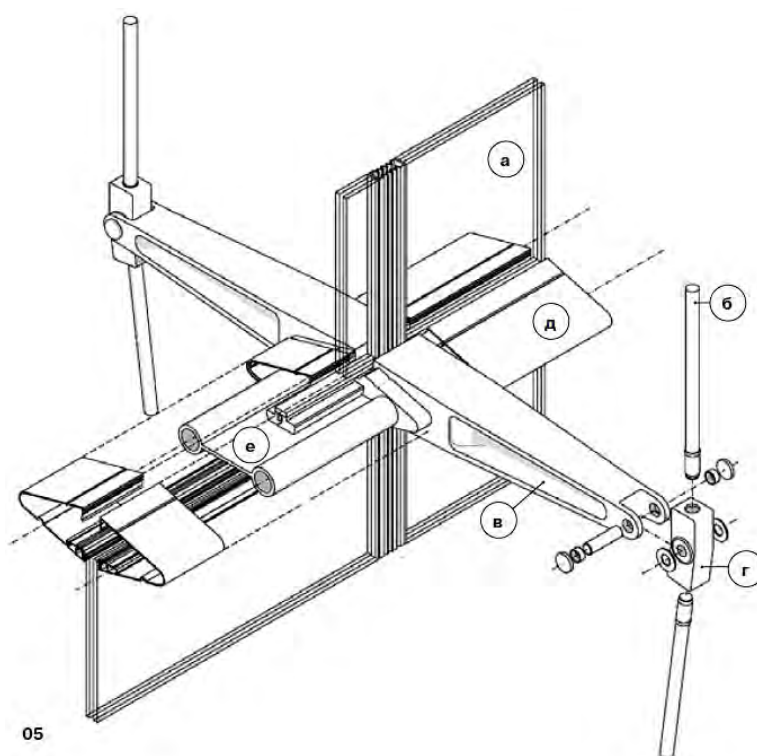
Узел крепления стекла в несущей конструкции фасада: *а* – двойной стеклопакет; *б* – металлический трос ($d=33$ мм); *в* – горизонтальный распор; *г* – анодированный соединительный элемент; *д* – алюминиевый накладной элемент; *е* – горизонтальная подконструкция ($d=76$ мм)
